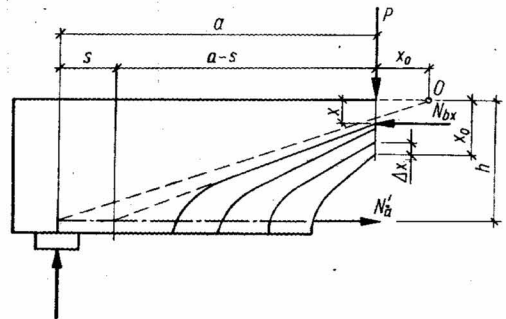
Etat final de fissuration dans la zone de cisaillement [43]
